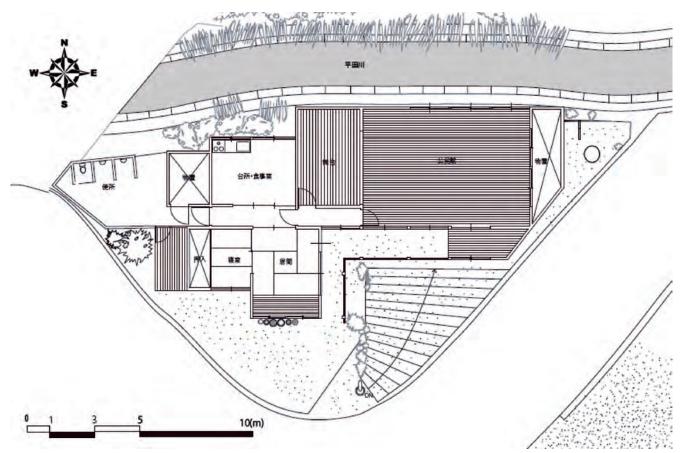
鉄輪温泉地区 谷の湯1F平面図
